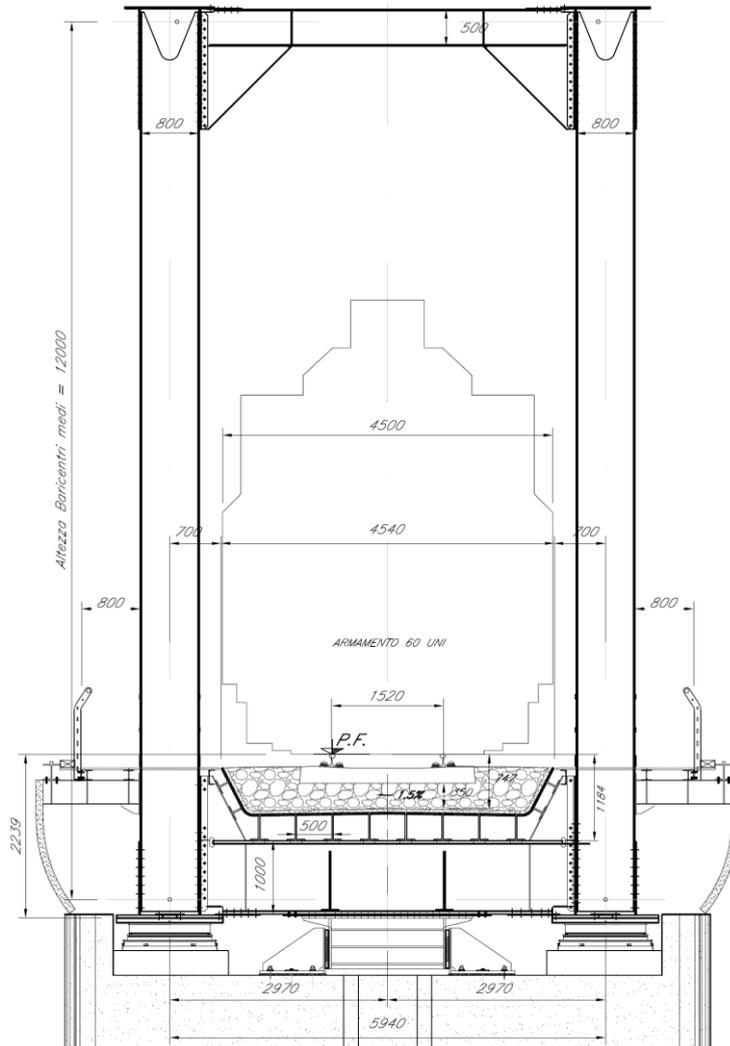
Sezione trasversale campata in acciaio L=70 m
